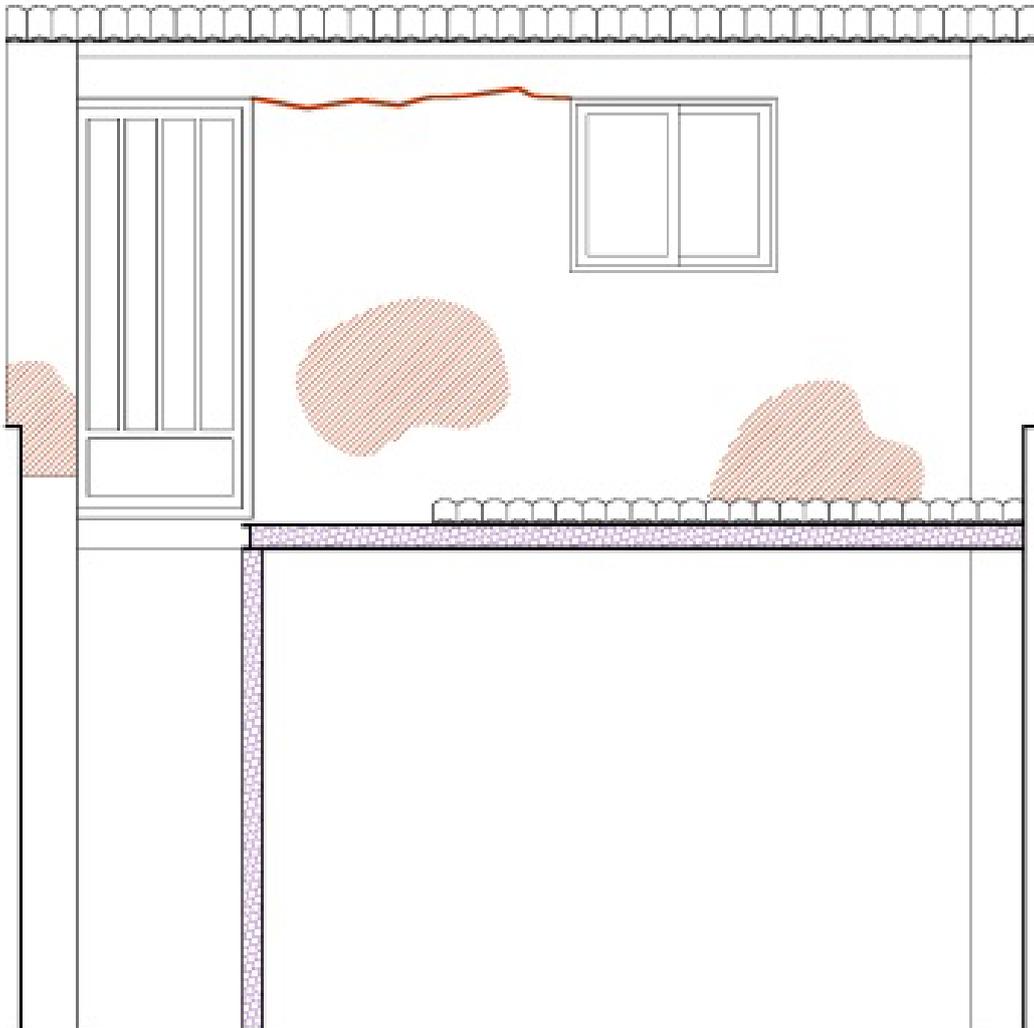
Plano patologías fachada cuerpo anexo (Plano nº 8, anexo II). Fuente propia.
